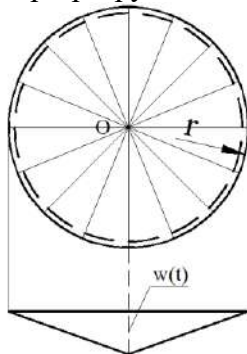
Напряженно– деформированное состояние и разрушения сталебетонной плиты при длительной нагрузке
